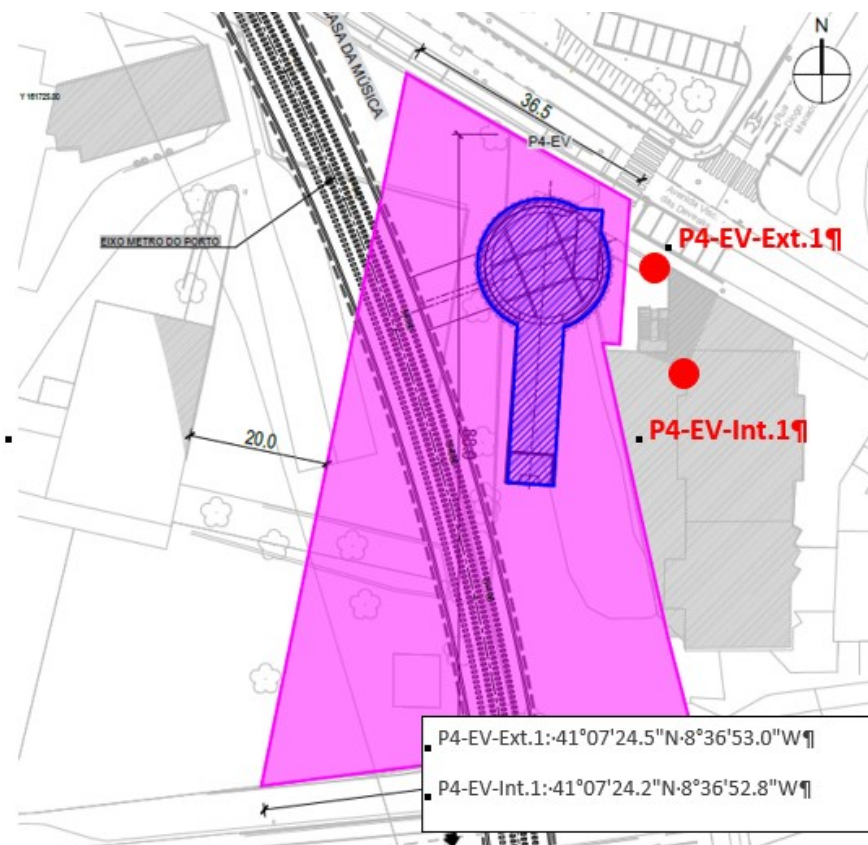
Pontos de monitorização junto a P4-EV (vibrações – construção)
